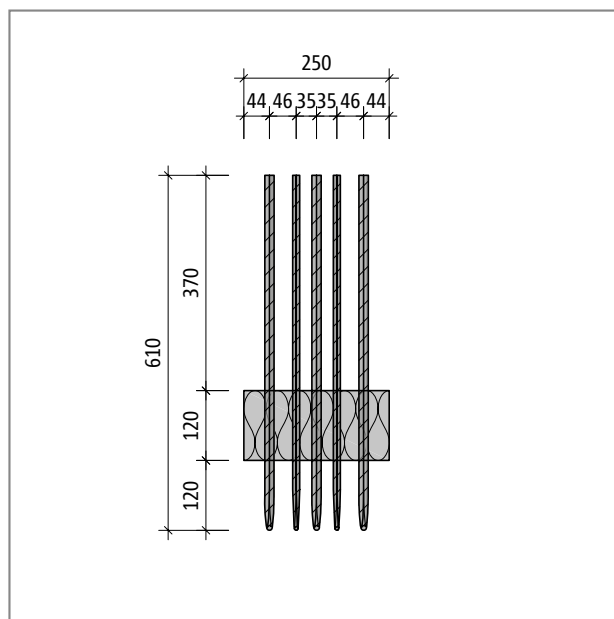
Schöck Isokorb® tipo ABXT, sezione longitudinale del prodotto
